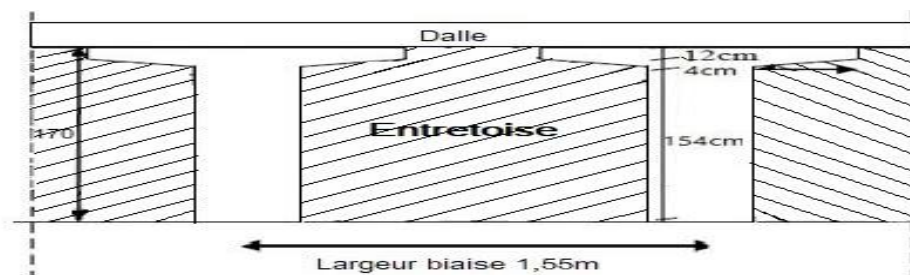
1 : Coupe longitudinale d'une entretoise (section hachurée)
